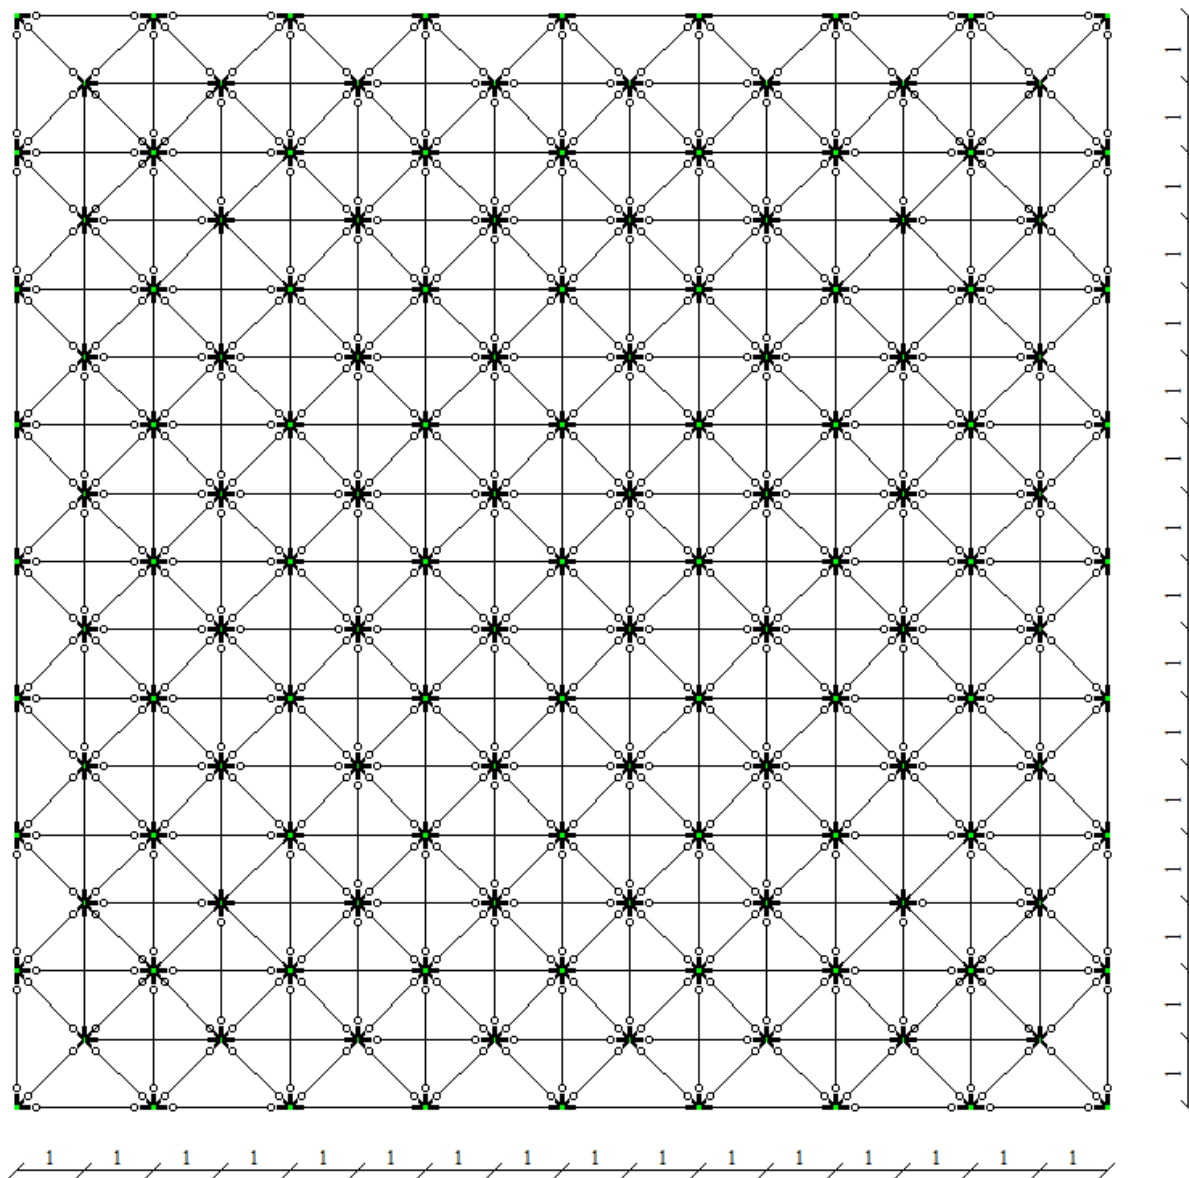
Проекция ХоУ расчетной схемы вариант №5.
